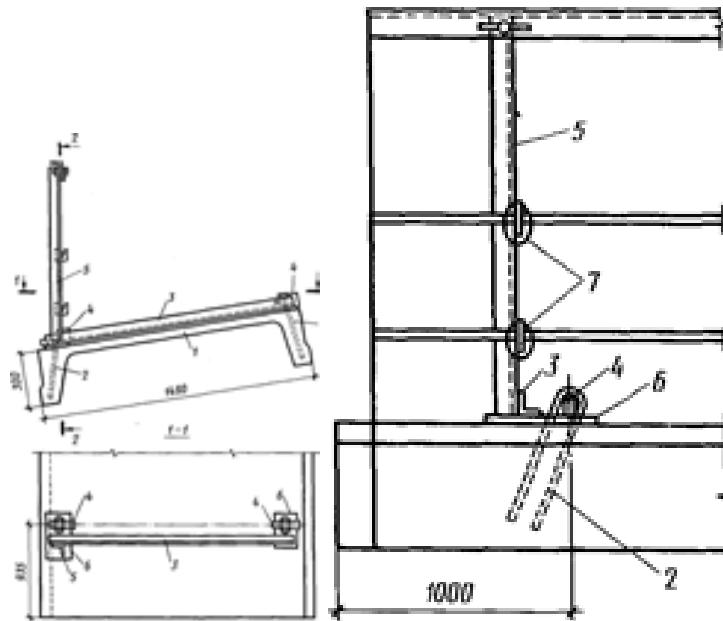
де 1 – залізобетонна плита; 2 – хомути; 3 – нижній елемент кріплення; 4 – дерев'яні клини; 5 – перильного стійка; 6 – планки кріплення; 7 – скрутки з дроту для закріплення огорож
